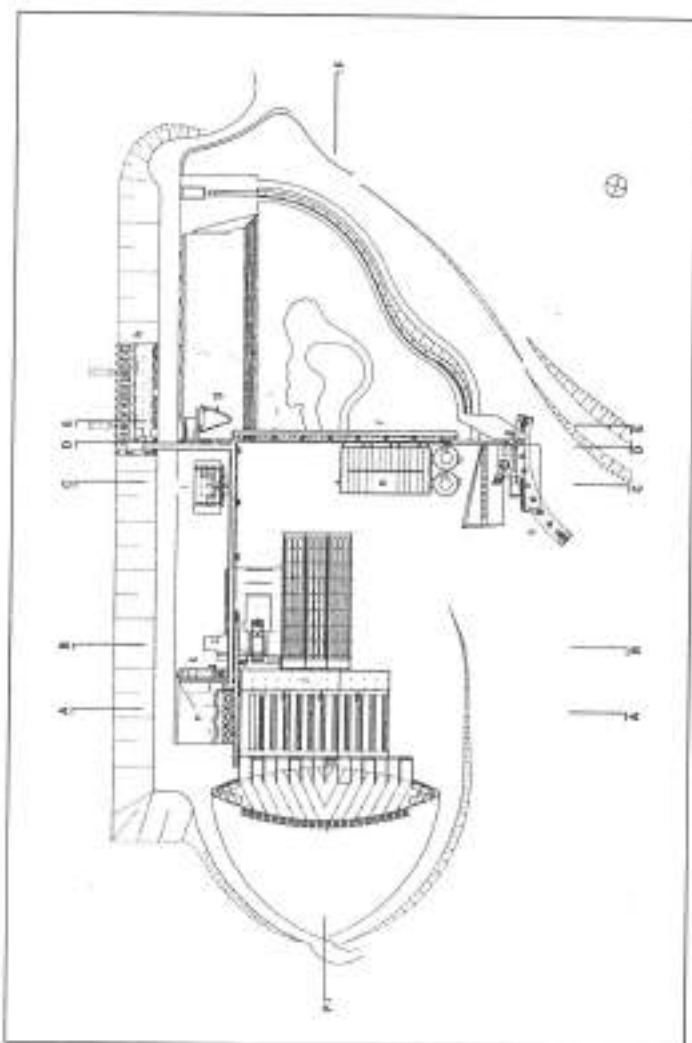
J. Stirling, *Stabilimento Braun*, Melsungen. Planimetria generale.
